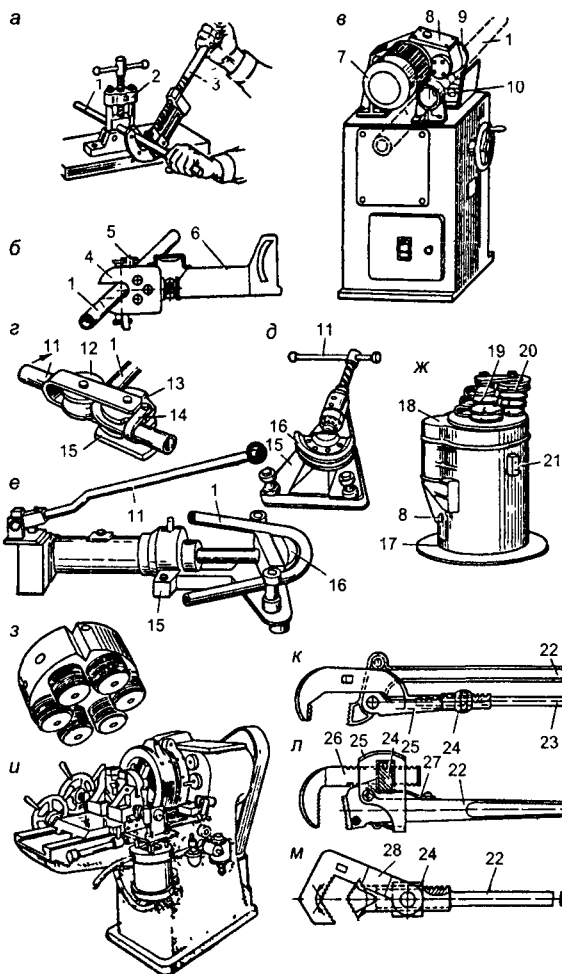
Приспособления, станки и инструменты, применяемые при заготовке сантехсистем из стальных труб:
